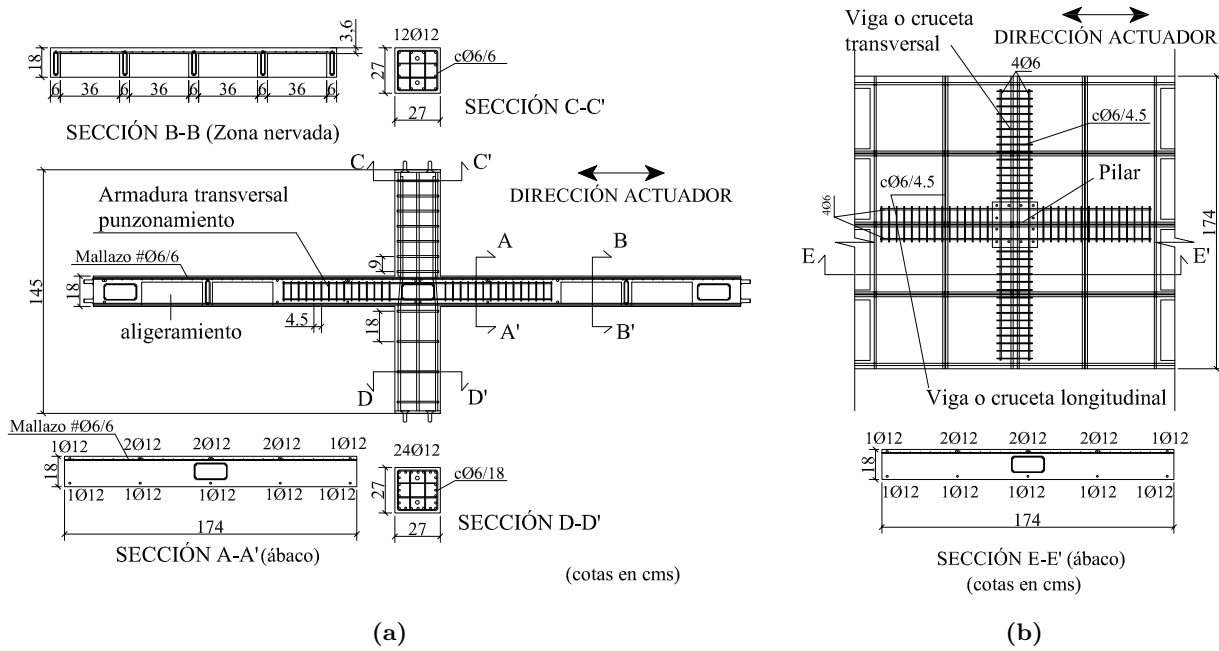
Geometría espécimen conexión interior: (a) alzado; (b) planta
